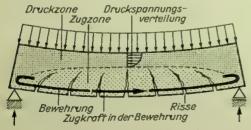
Wirkungsweise eines biegebeanspruchten Stahlbetonbauteiles
